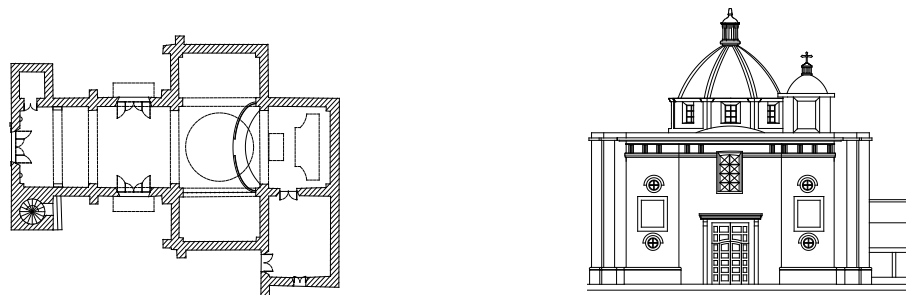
Planta arquitectónica y fachada típica de las iglesias de Colima
